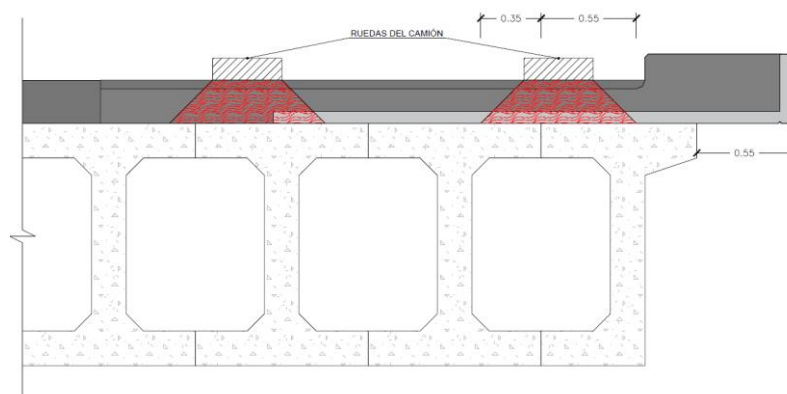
Sección transversal del tablero en vano sobre ff.cc.
